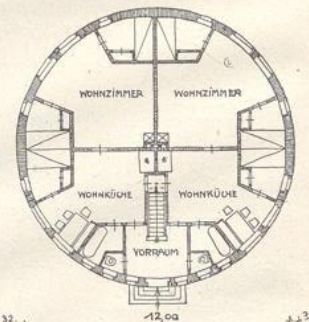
Beispiel zu Form 3 (vgl. Abb. 2). Eingeschossiges Wohnhaus mit 2 Wohnungen.
